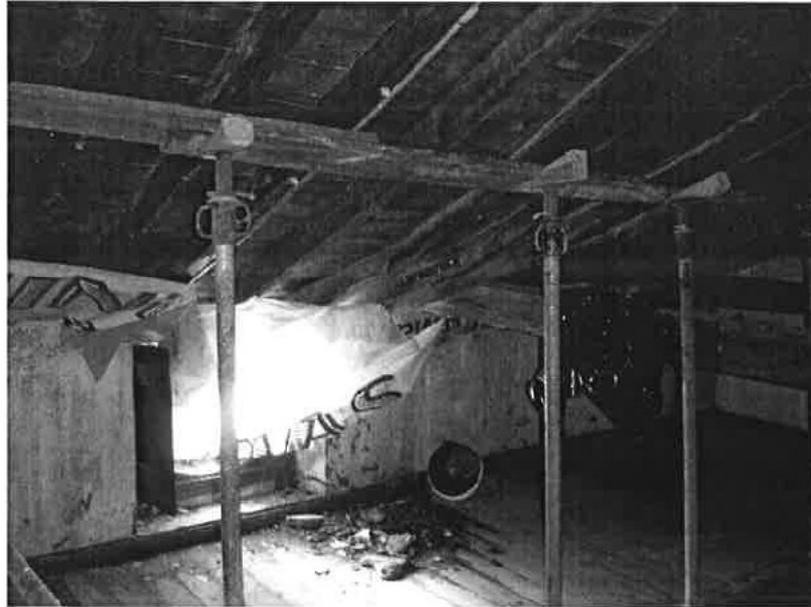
( Deformação da cobertura na zona das infiltrações)
